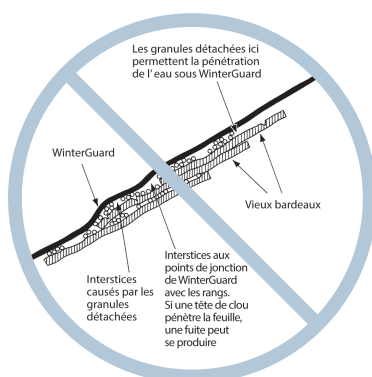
Problèmes d'installation du WinterGuard sur un vieux toit.
